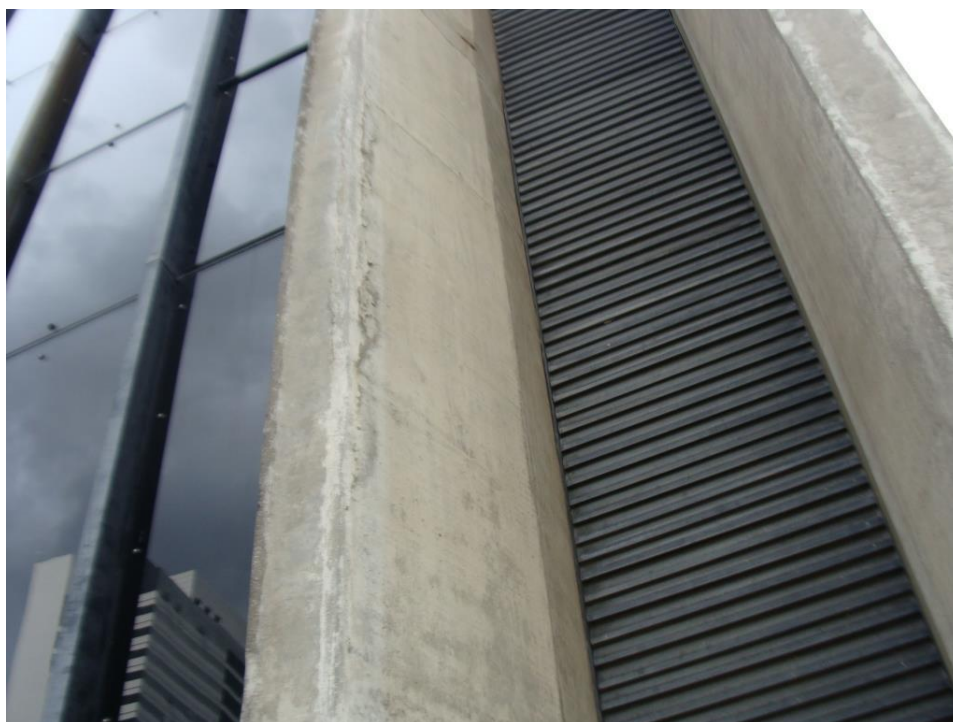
Armadura exposta pilar P14 (1º pavimento) (02/03/2021)
